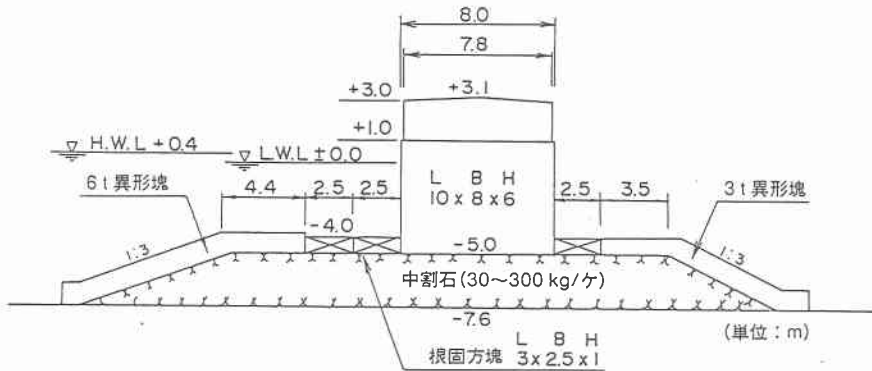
奥尻港北防波堤 (C 部) 標準断面図
